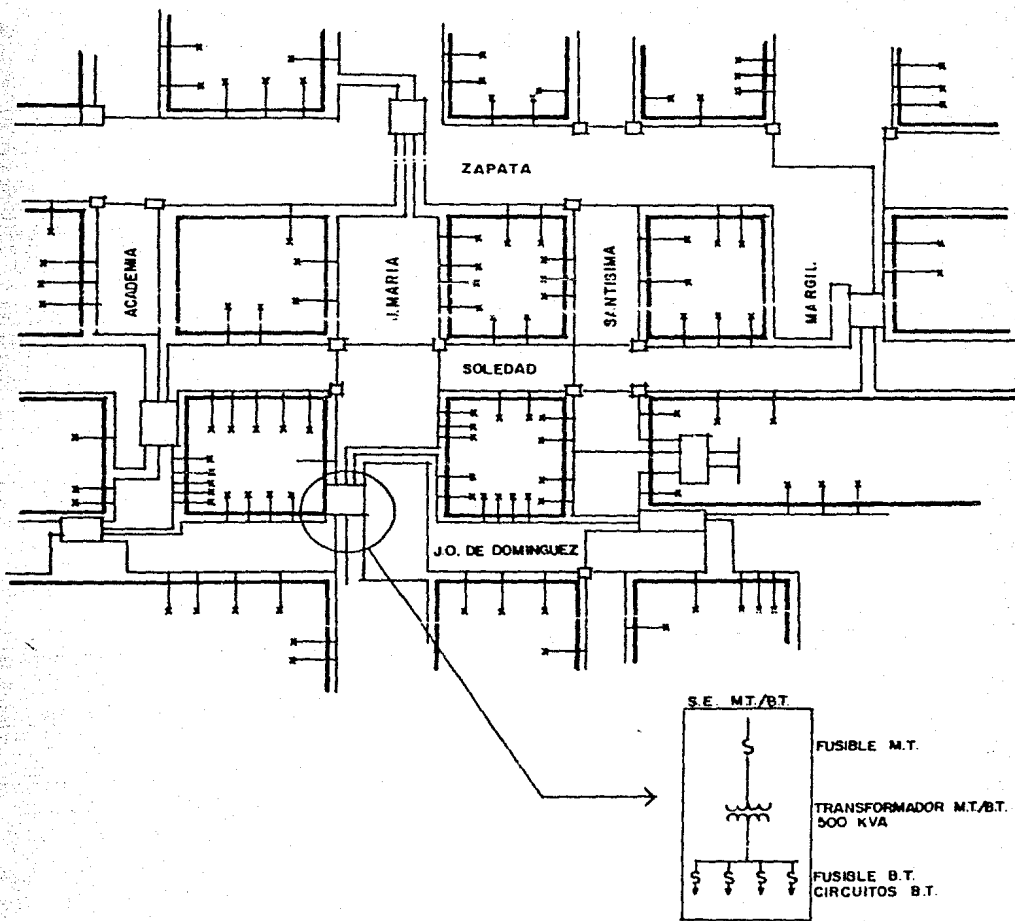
Estructura de baja tensión con seccionamiento
